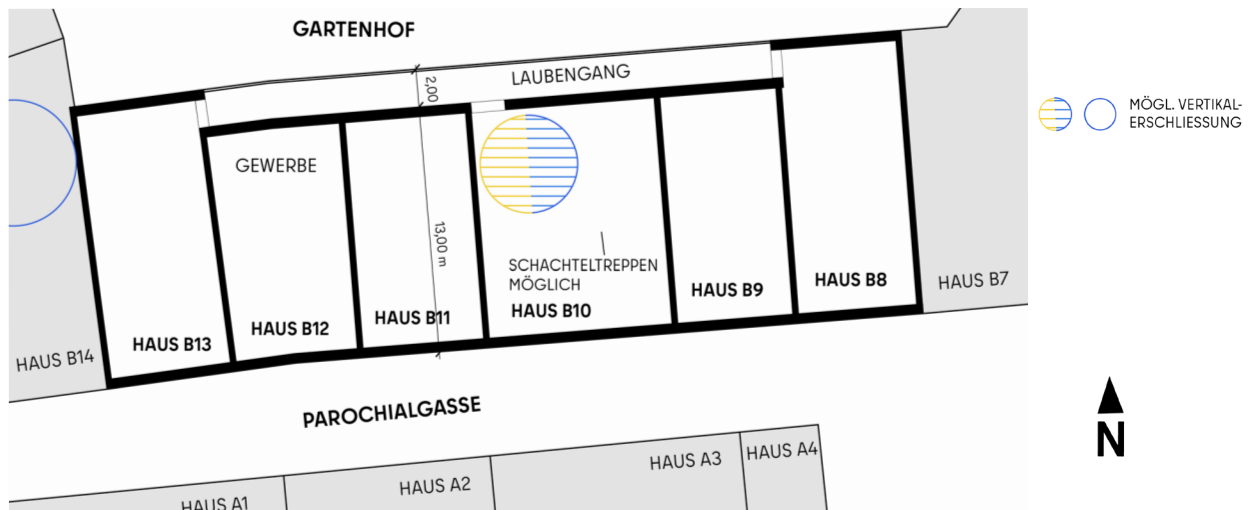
Schematischer Grundriss 1. Obergeschoss
